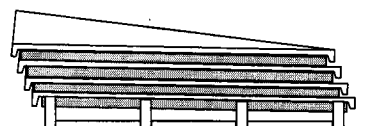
Corte longitudinal esquemático do empilhamento das peças
